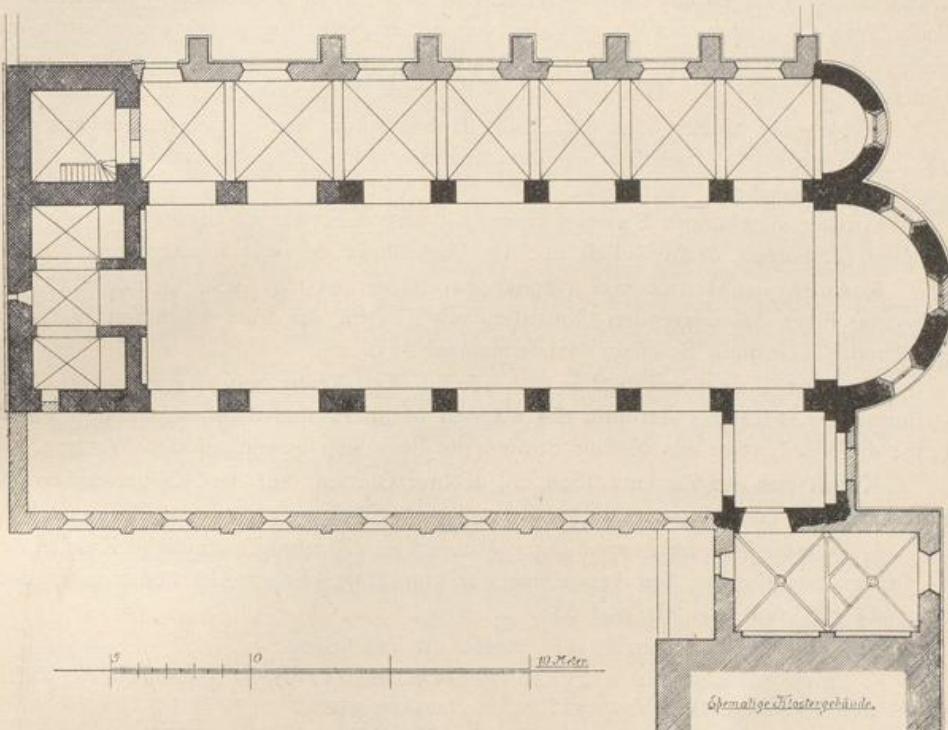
Dünnwald. Grundriss der katholischen Pfarrkirche.
